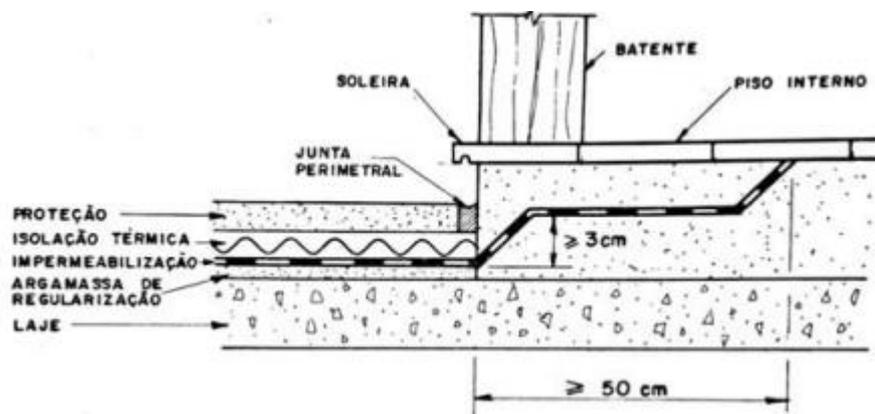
Detalhamento da impermeabilização soleira (PICCHI, 1986).
